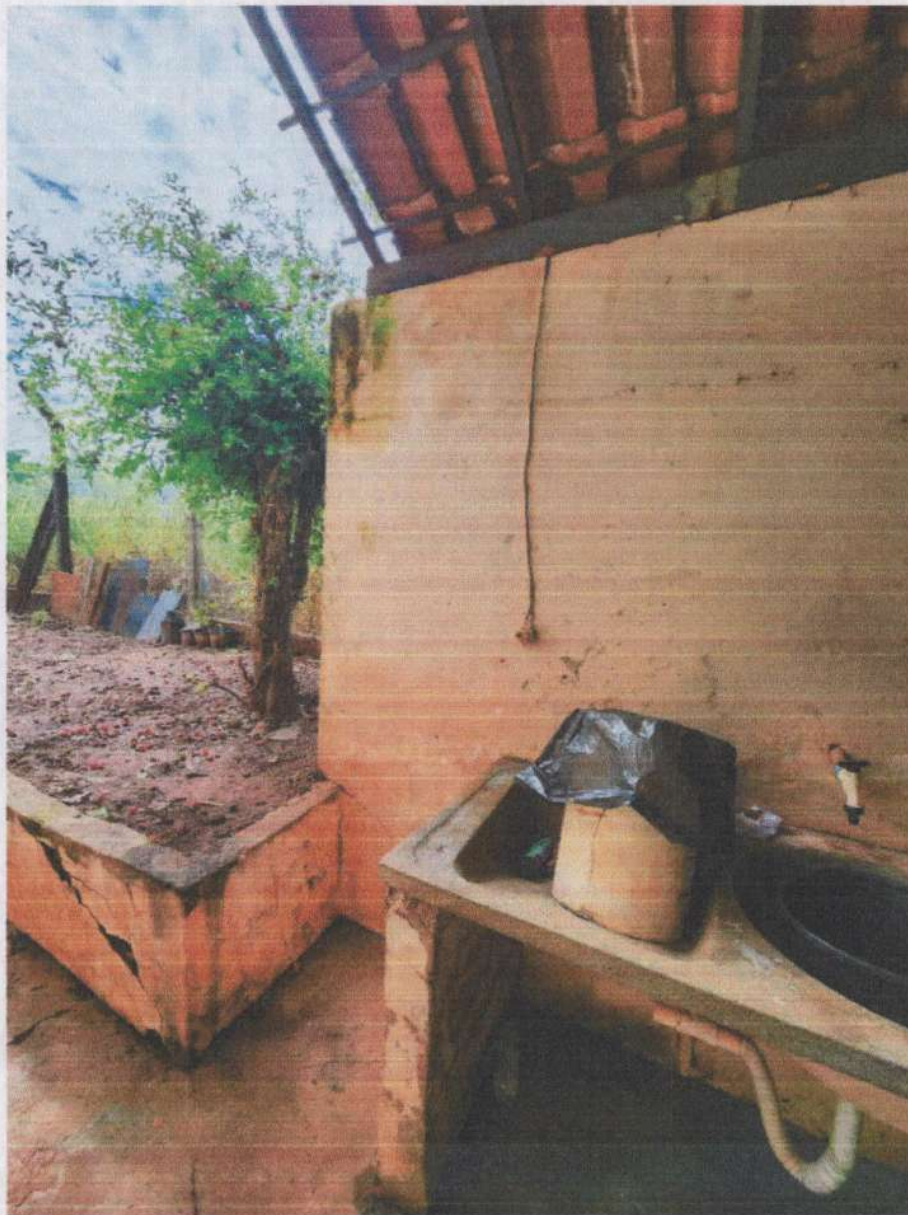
Fissuras e rachaduras aparentes devido a recalques da estrutura, telhado deteriorado, patologias e infiltrações generalizadas, mofo, bolor e ferragens com sinais de oxidação e corrosão.
